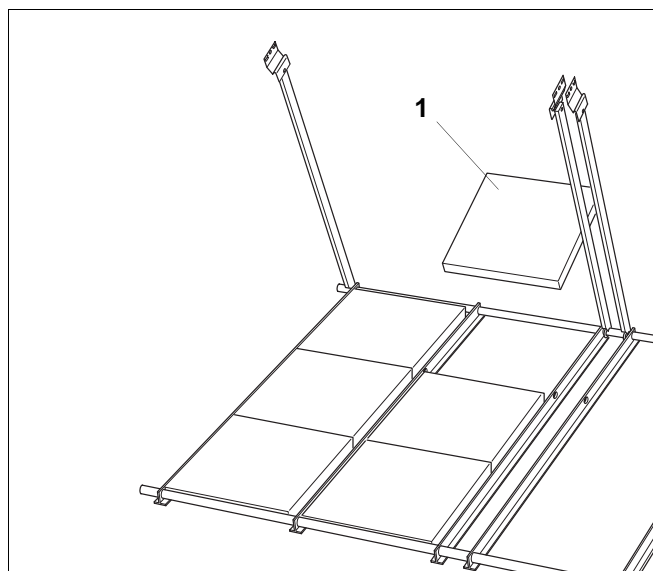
Stabilisieren der Flachdächer mit Betonplatten
